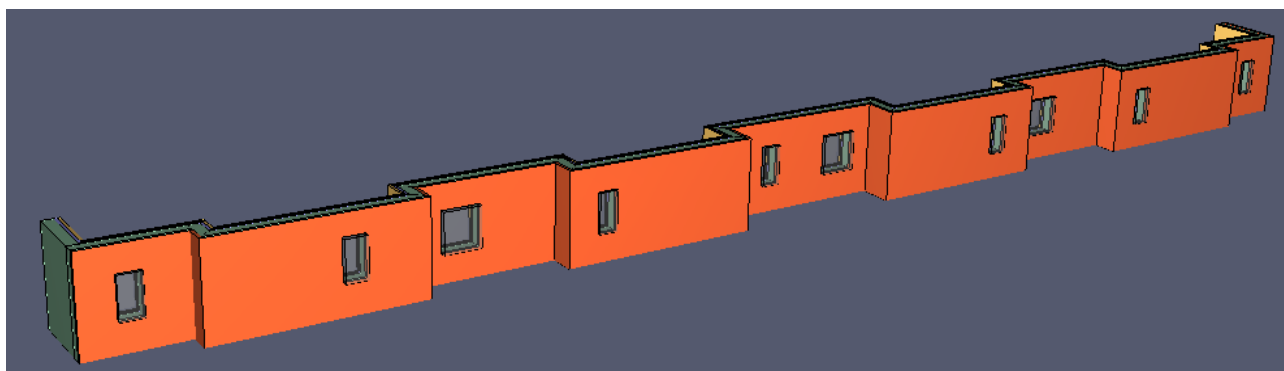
Повна геометрична схема розрахункової області фасаду будівлі
